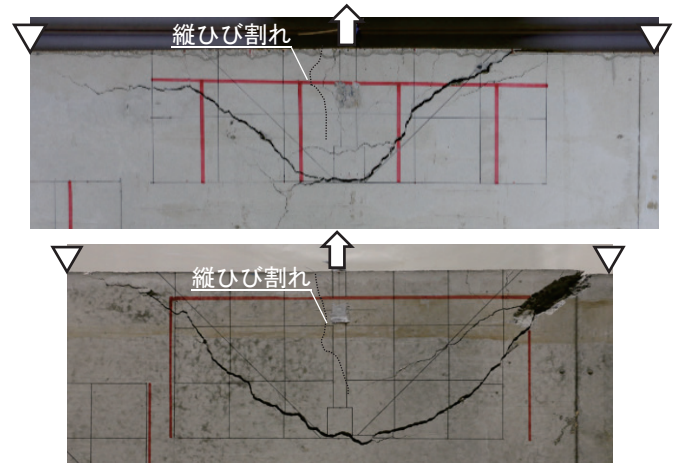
試験体破壊状況 (上: No.2 下: No.106)
